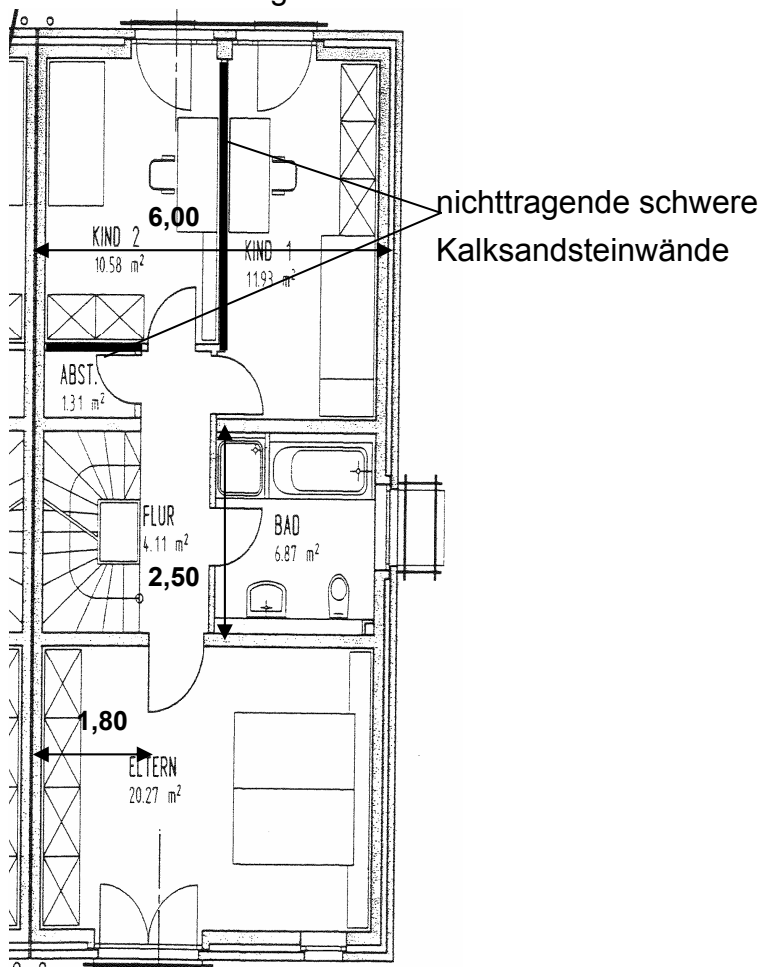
Grundriss des Obergeschosses einer typischen Doppelhaushälfte
